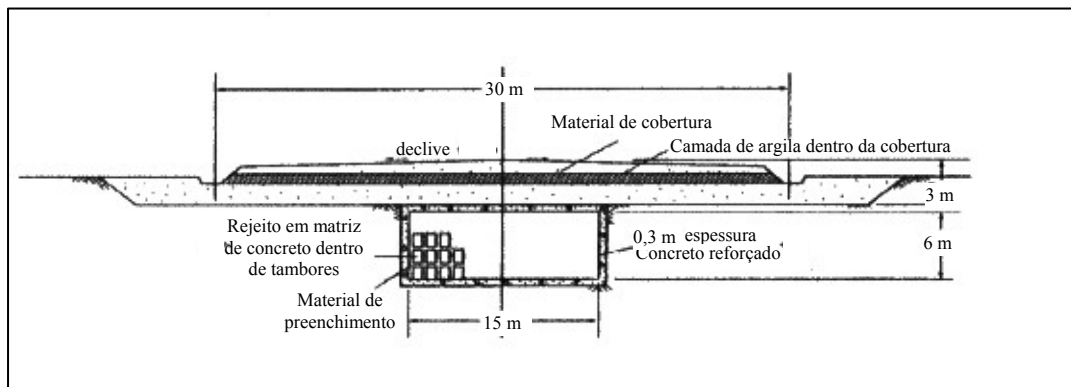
Seção transversal do repositório tipo cripta de concreto pós-fechamento.
